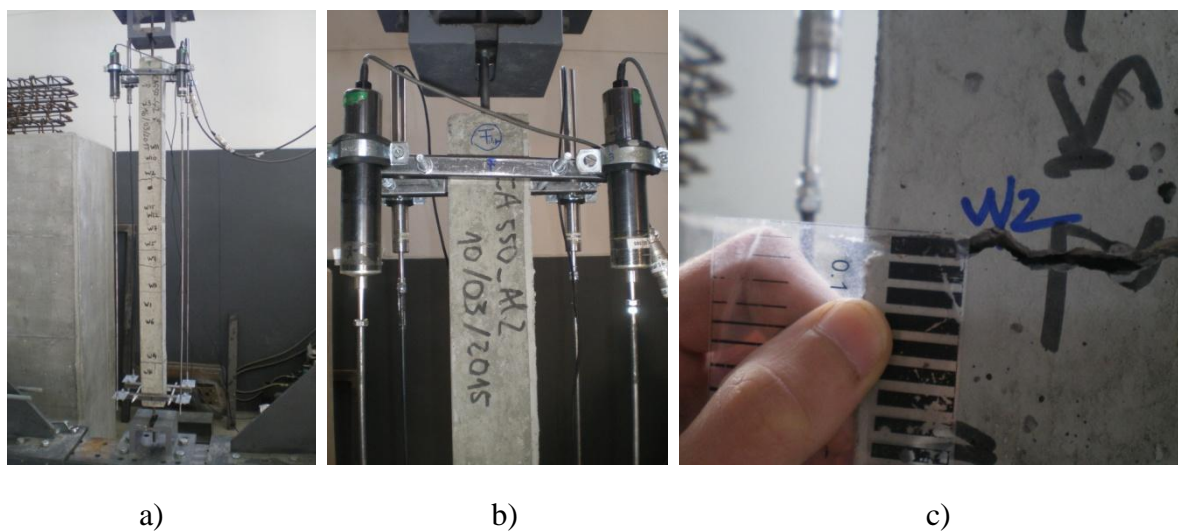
Ensaio tirante em execução: a) Perspetiva geral do ensaio; b) Pormenor LVDT's; c) Leitura da largura de fendas.
